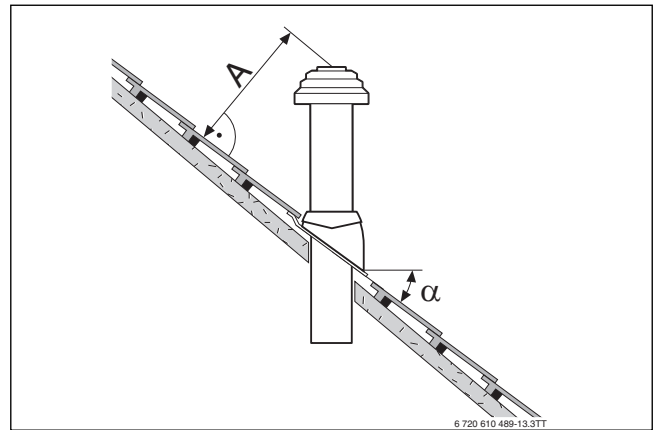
Abstandsmaße und Dachneigungen bei Schrägdach
